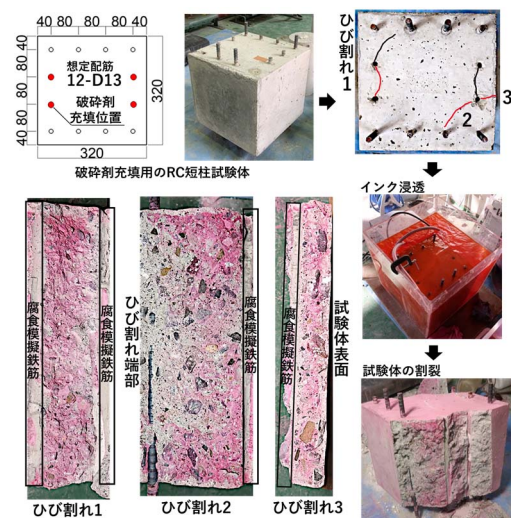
試験体概要および模擬腐食ひび割れ性状
